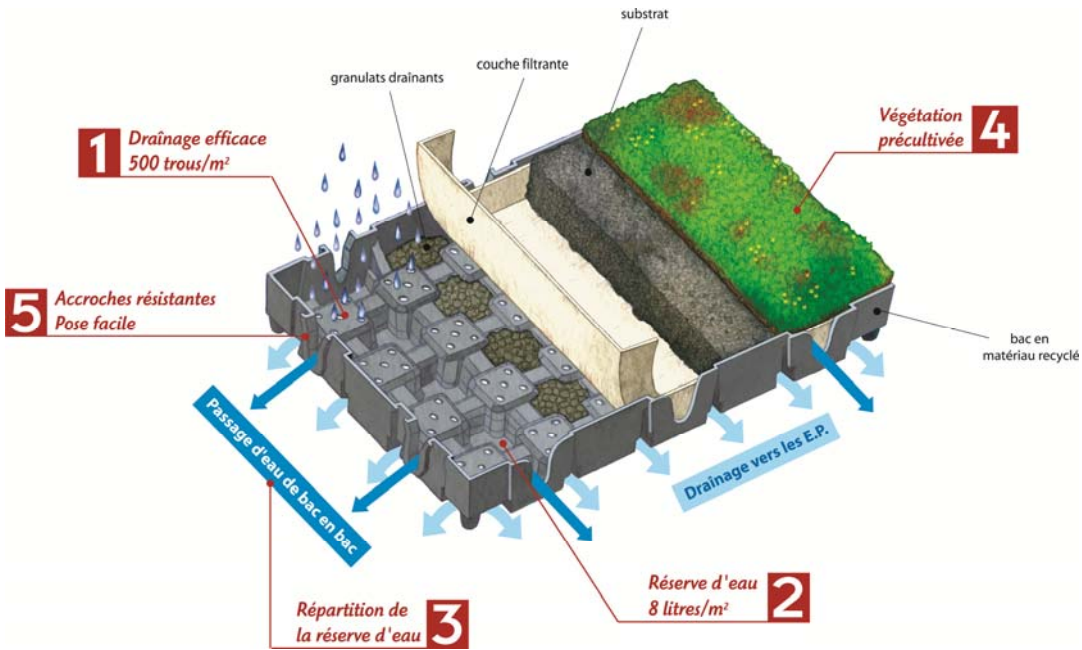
Coupe transversale d'un bac HYDROPACK®
